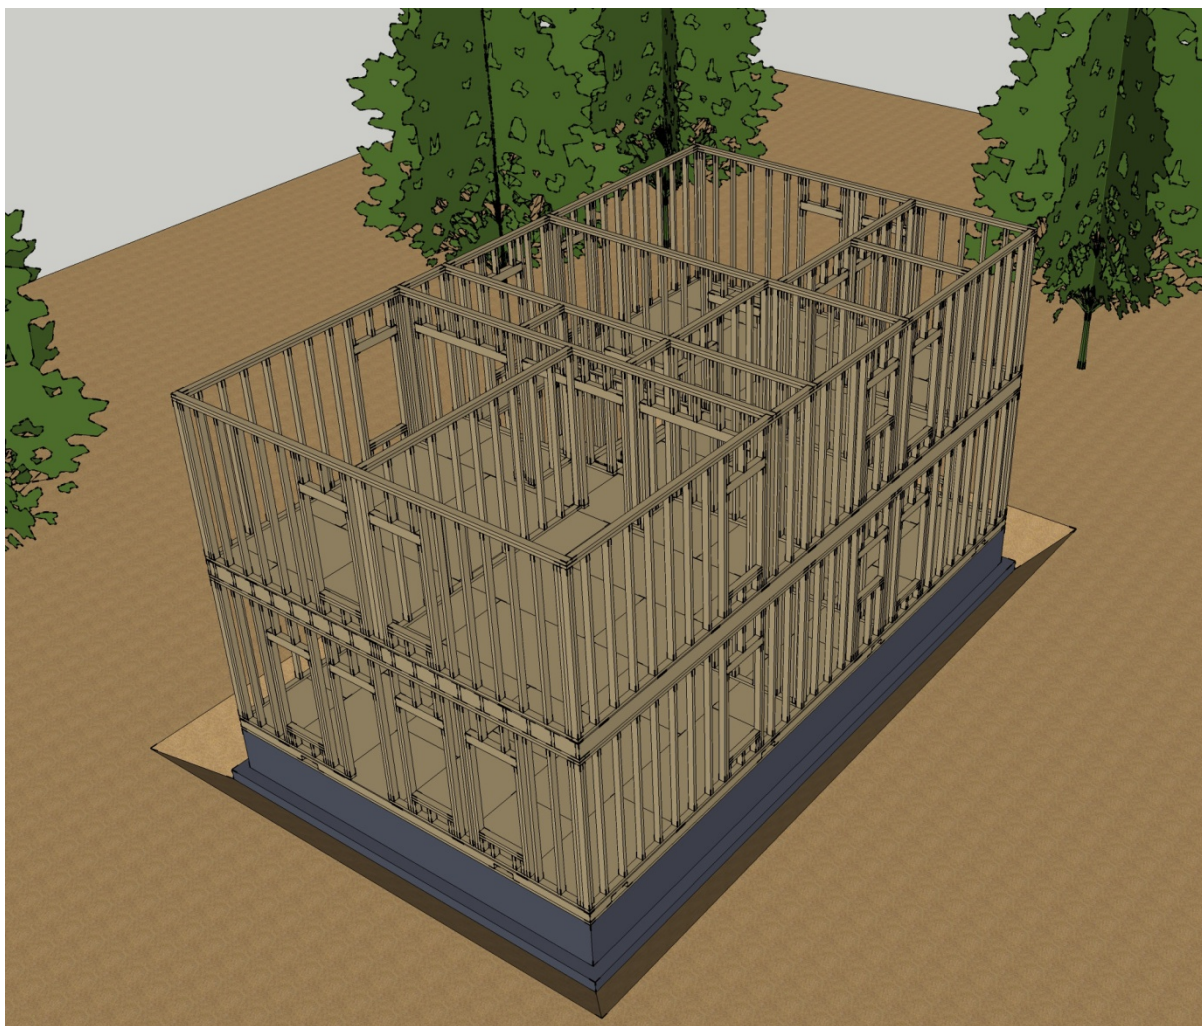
Montagem das paredes interiores no sentido longitudinal e respectivo travamento às outras paredes.
